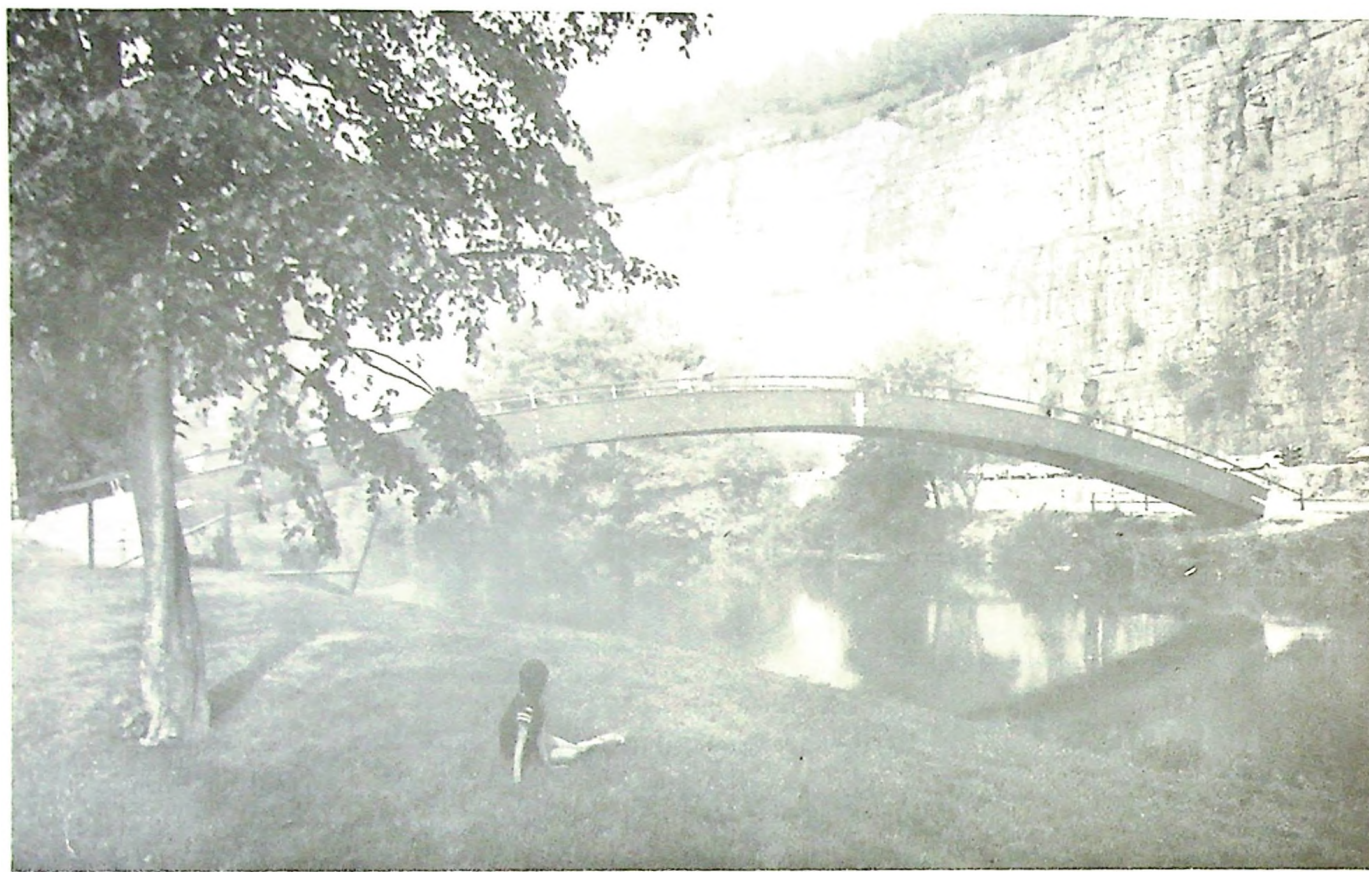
Arco laminado colado triarticulado: ponte para pedestre. Foto retirada da revista alemã "Informationsdienst Holz."
